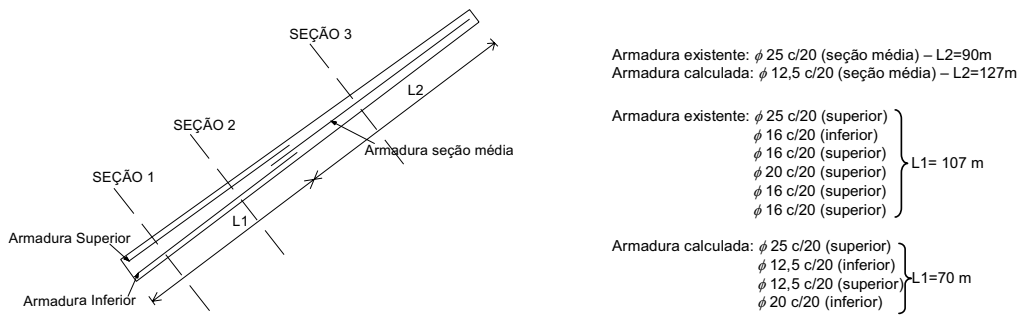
Disposição das armaduras (Goulart, 2004).
